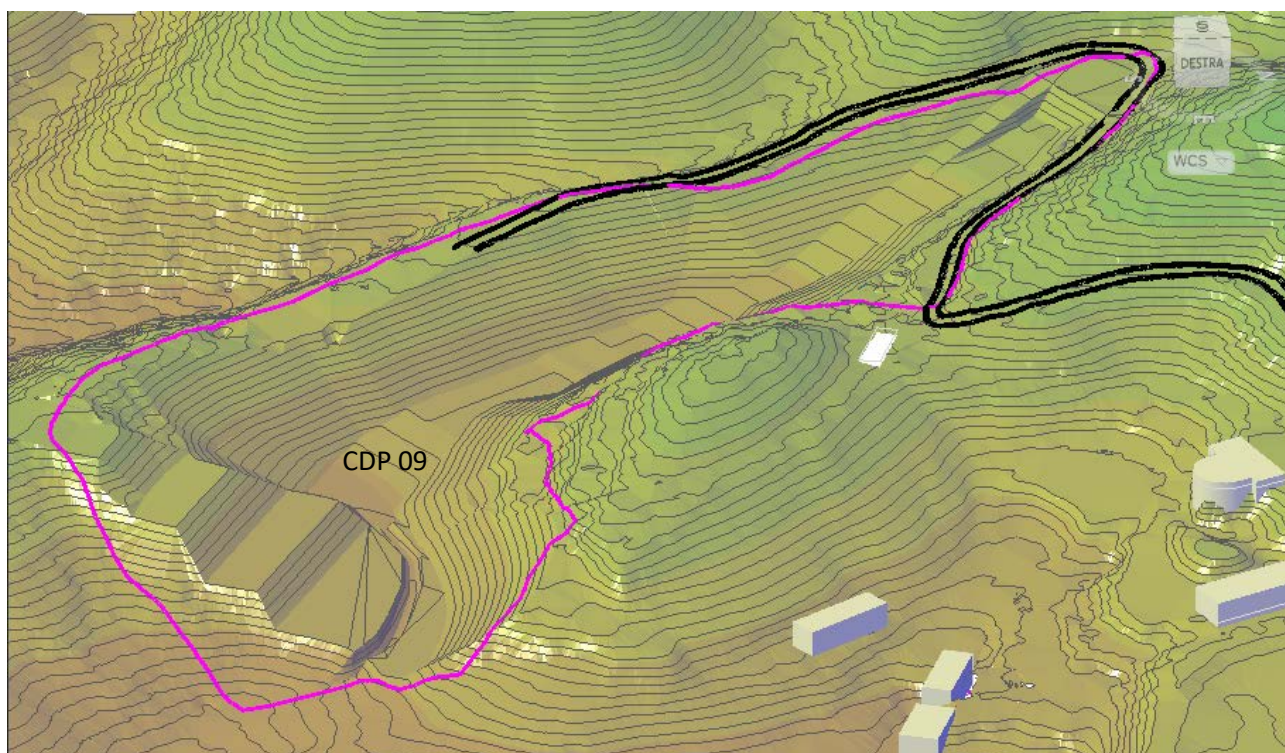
VISTA 3D DELLO STATO DI PROGETTO – FASE 2 Cdp MA9 (VISTA DA E)
